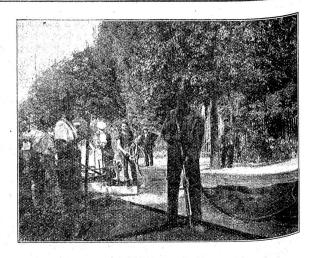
Neue Betonstraße Arbon. Stampshammer auf dem Unterbeton; diagonale Gifeneinlage im Oberbeton.
